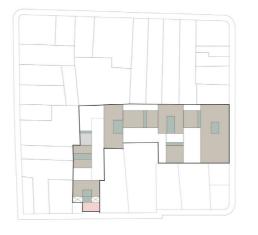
Zonificación Primera Planta Alta Fuente: Autores, 2022
